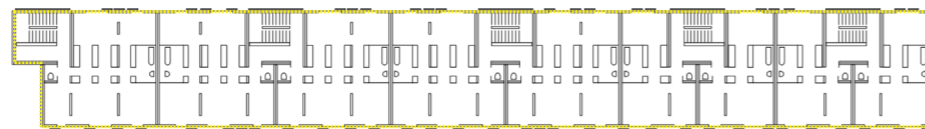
, planta general, viviendas Straßgang, Riegler y Riewe. 1994
